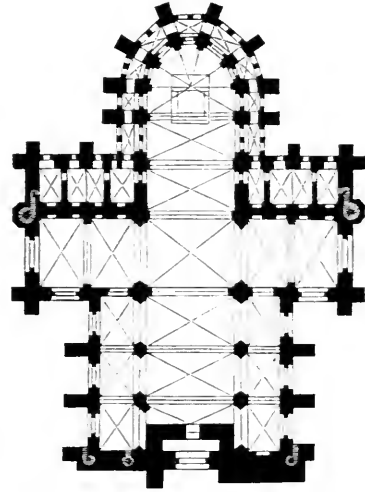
Grundriß der Kirche zu Wilsnaa.
